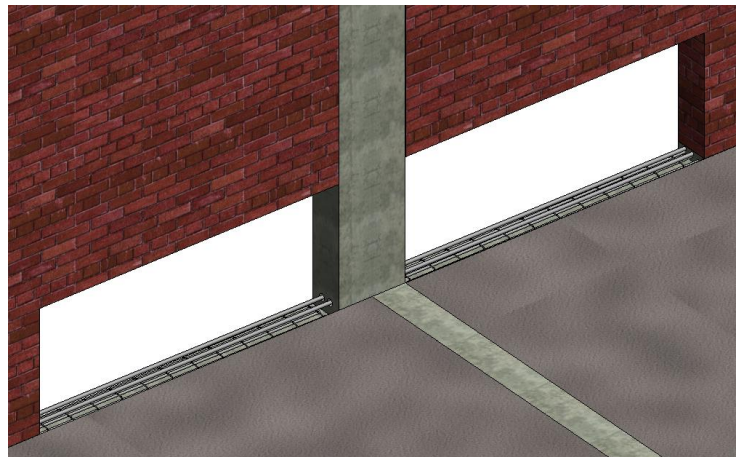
Abertura da alvenaria e retirada de camada de concreto
